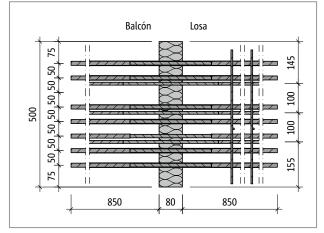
Schöck Isokorb® T tipo K-M14-V1: Plano del producto
